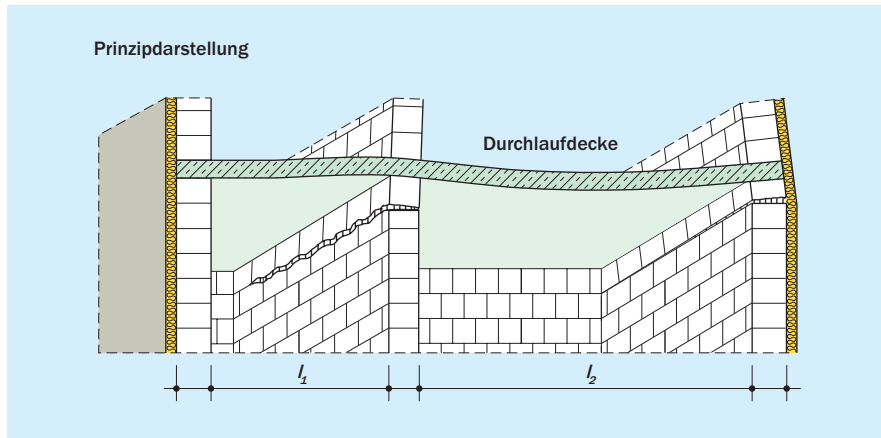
Rissbildung infolge großer Deckendurchbiegung
